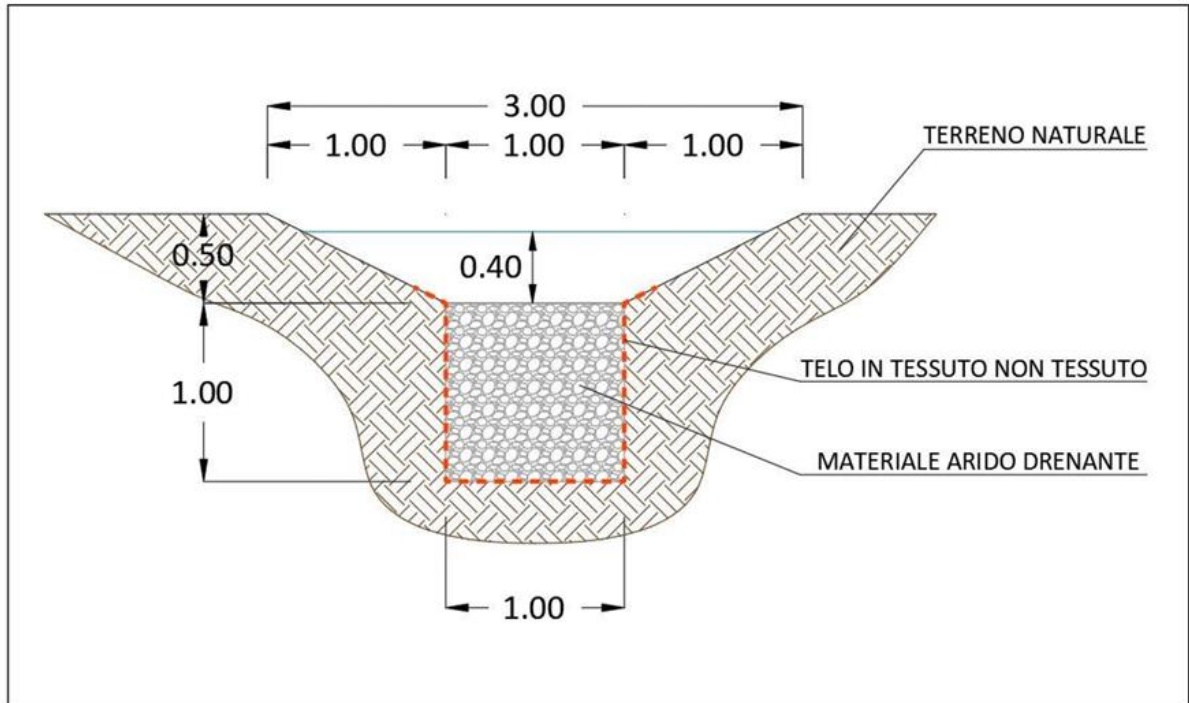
SEZIONE TRASVERSALE SISTEMA FOSSI + TRINCEE
